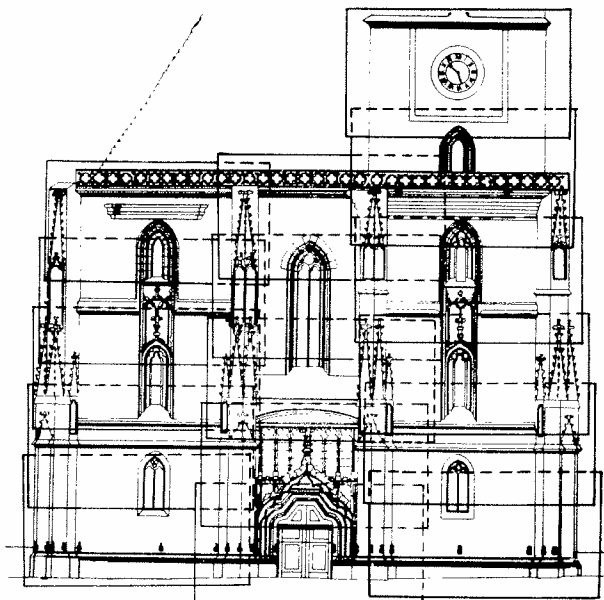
Schema d'arrangement des couples photogrammétriques de la façade d'Ouest.
